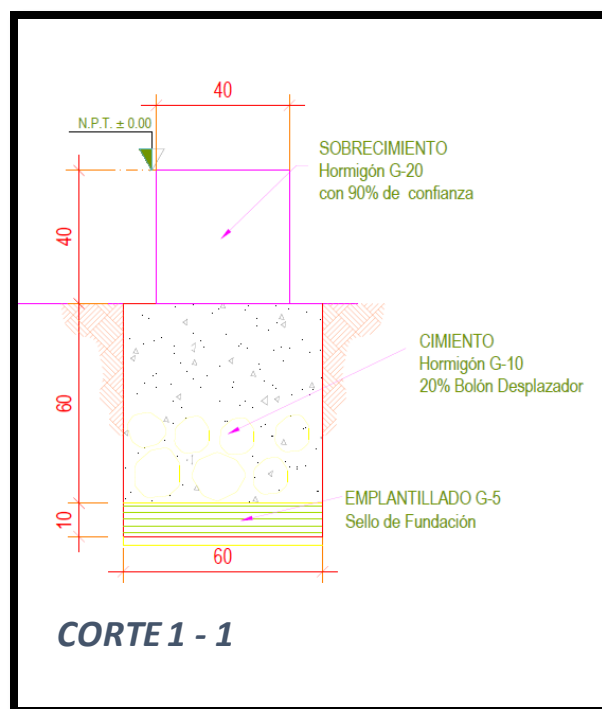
“Corte de fundación para muros de tapial en 40 cm”
